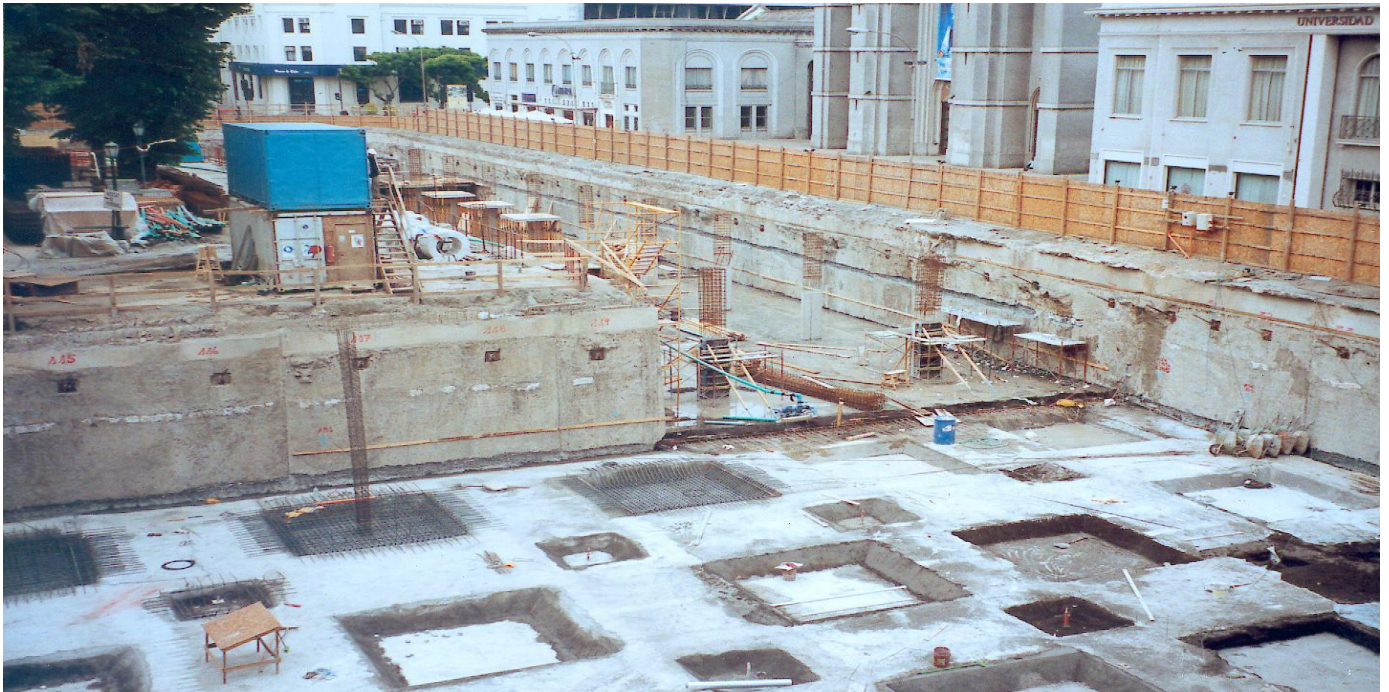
Vista general del muro pantalla perimetral anclado y micropilotes entre fundaciones de columnas
